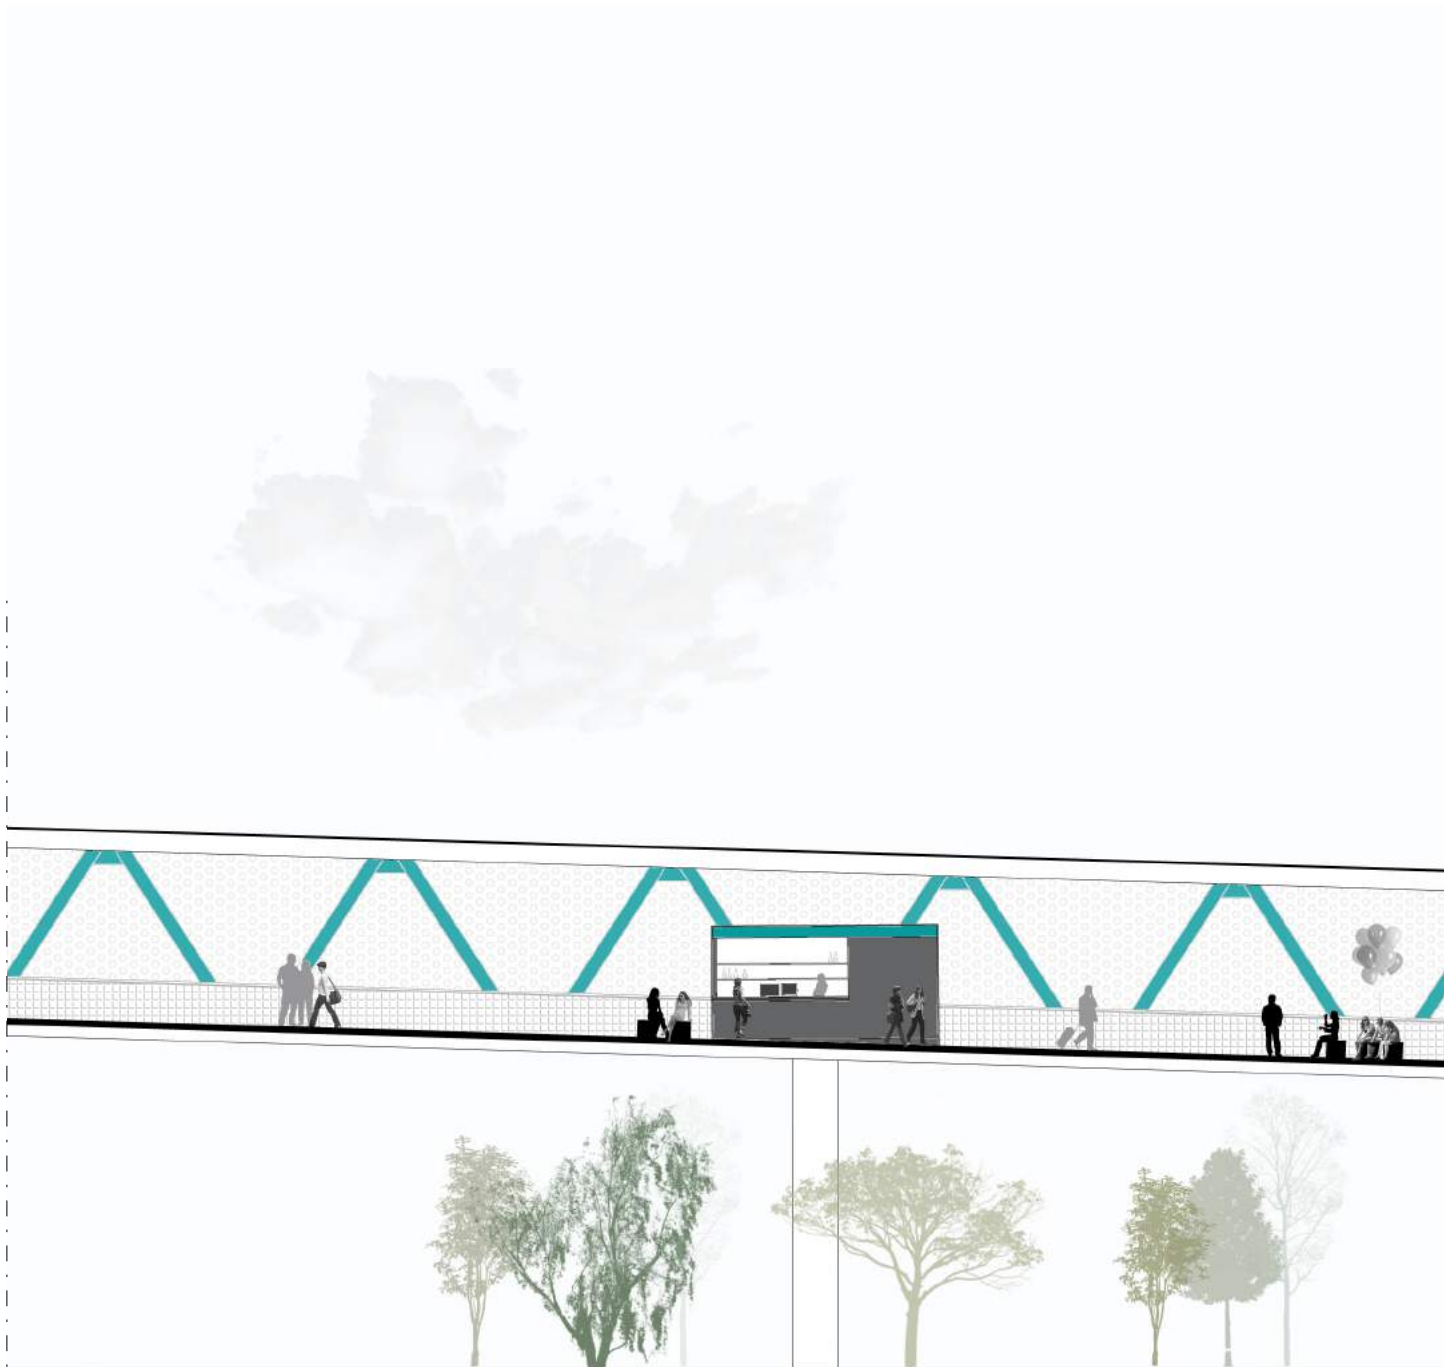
Secondo tratto della passerella con vista trasversale dei chioschi; sezione AA'
